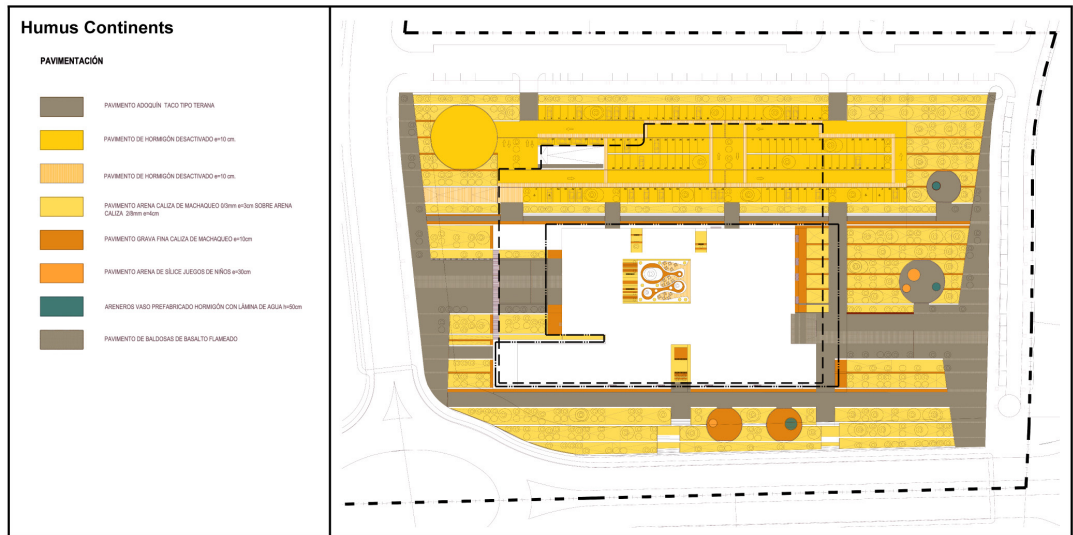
Plano de pavimentos. Dehesa Paisaje Caja de Badajoz, 2011. Proyecto de Arquitectura: Estudio Lamela. Plano de Paisajismo: Cristina Jorge.
